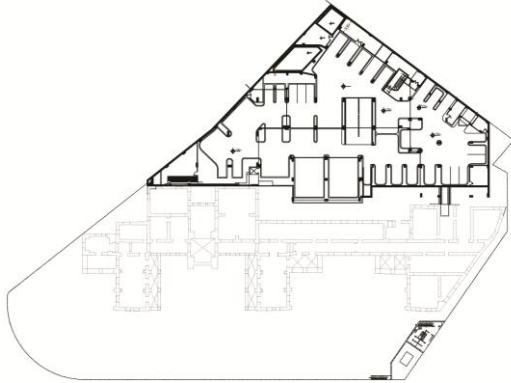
المسقط الأفقي لطابق السطح.
